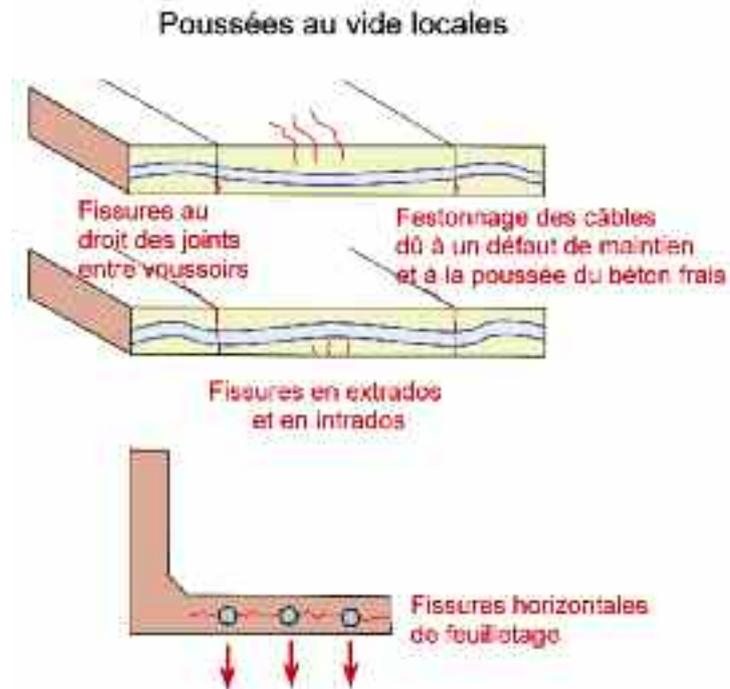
causes de poussées au vide engendrées par un festonnage des câbles (pas assez de points de fixation pour les gaines, personnel marchant sans précaution sur les conduits...)
